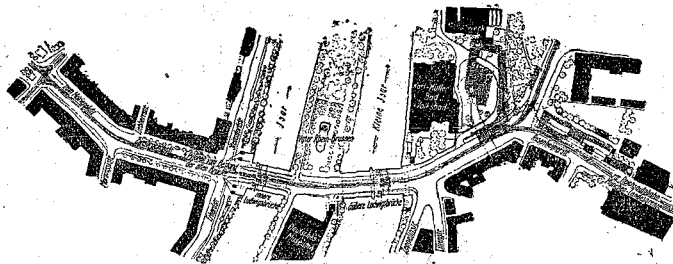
Lageplan der neuen Ludwigsbrücken.
